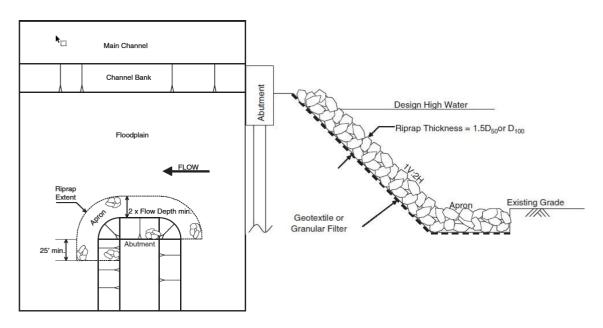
Geometría Para Diseño De Enrocados En Estribos
